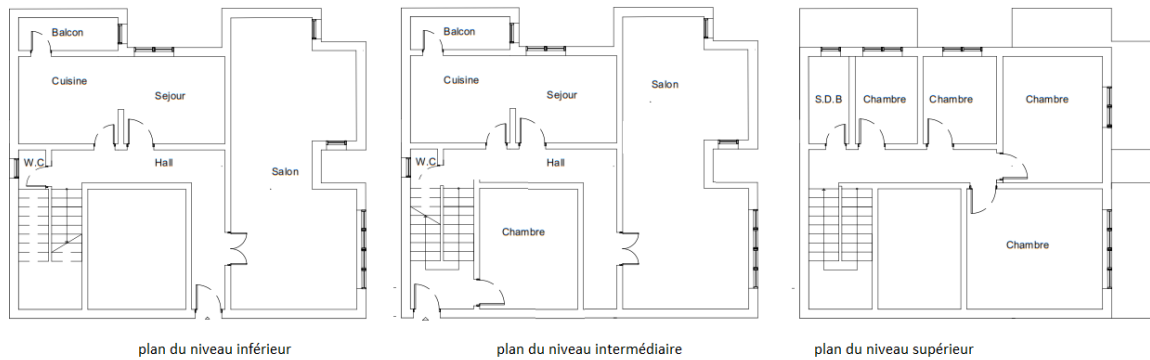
Plans modifiés des trois niveaux d'un logement F4. 1<sup>er</sup> cas
